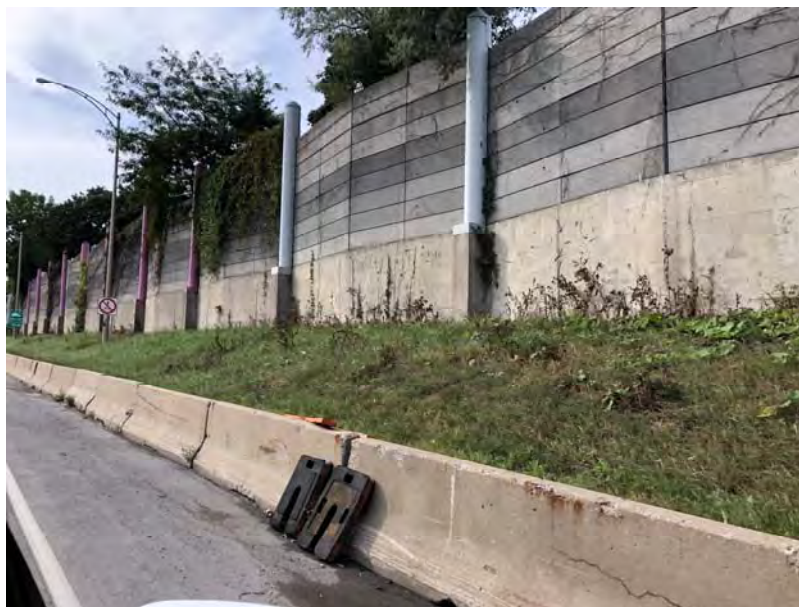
Vue des murs anti-bruit à l'est de l'A15S construits sur du remblai (km 0+000 à 0+600) (source : photographie prise le 9 septembre 2021)
